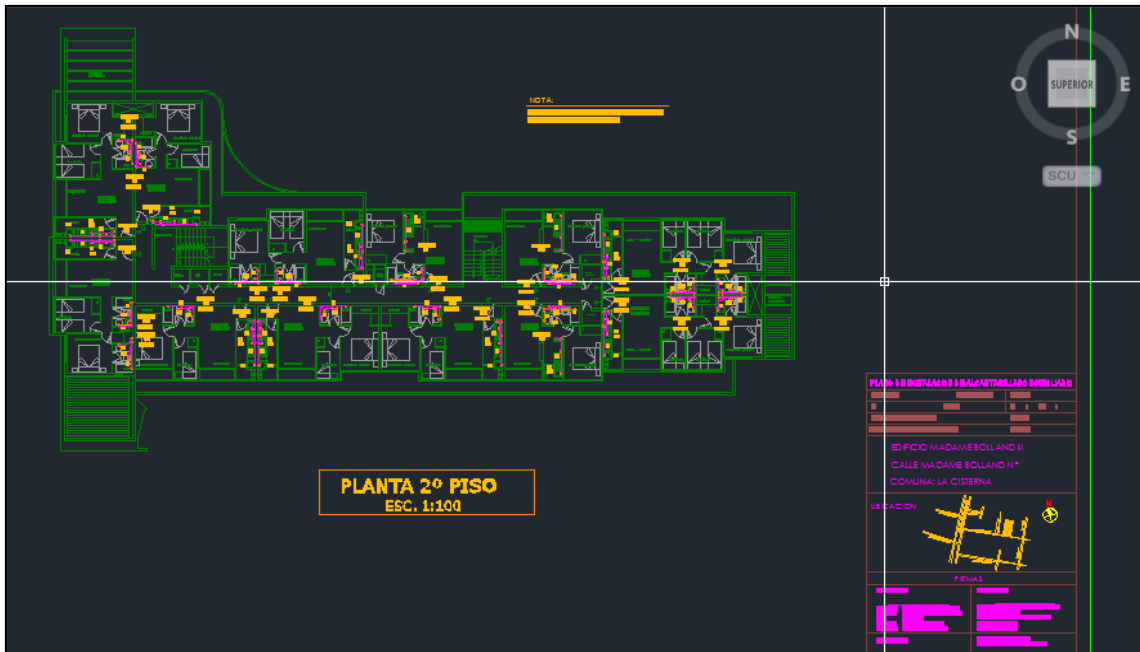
Planos As Built, Alcantarillado Piso N° 2 al Piso N° 5
